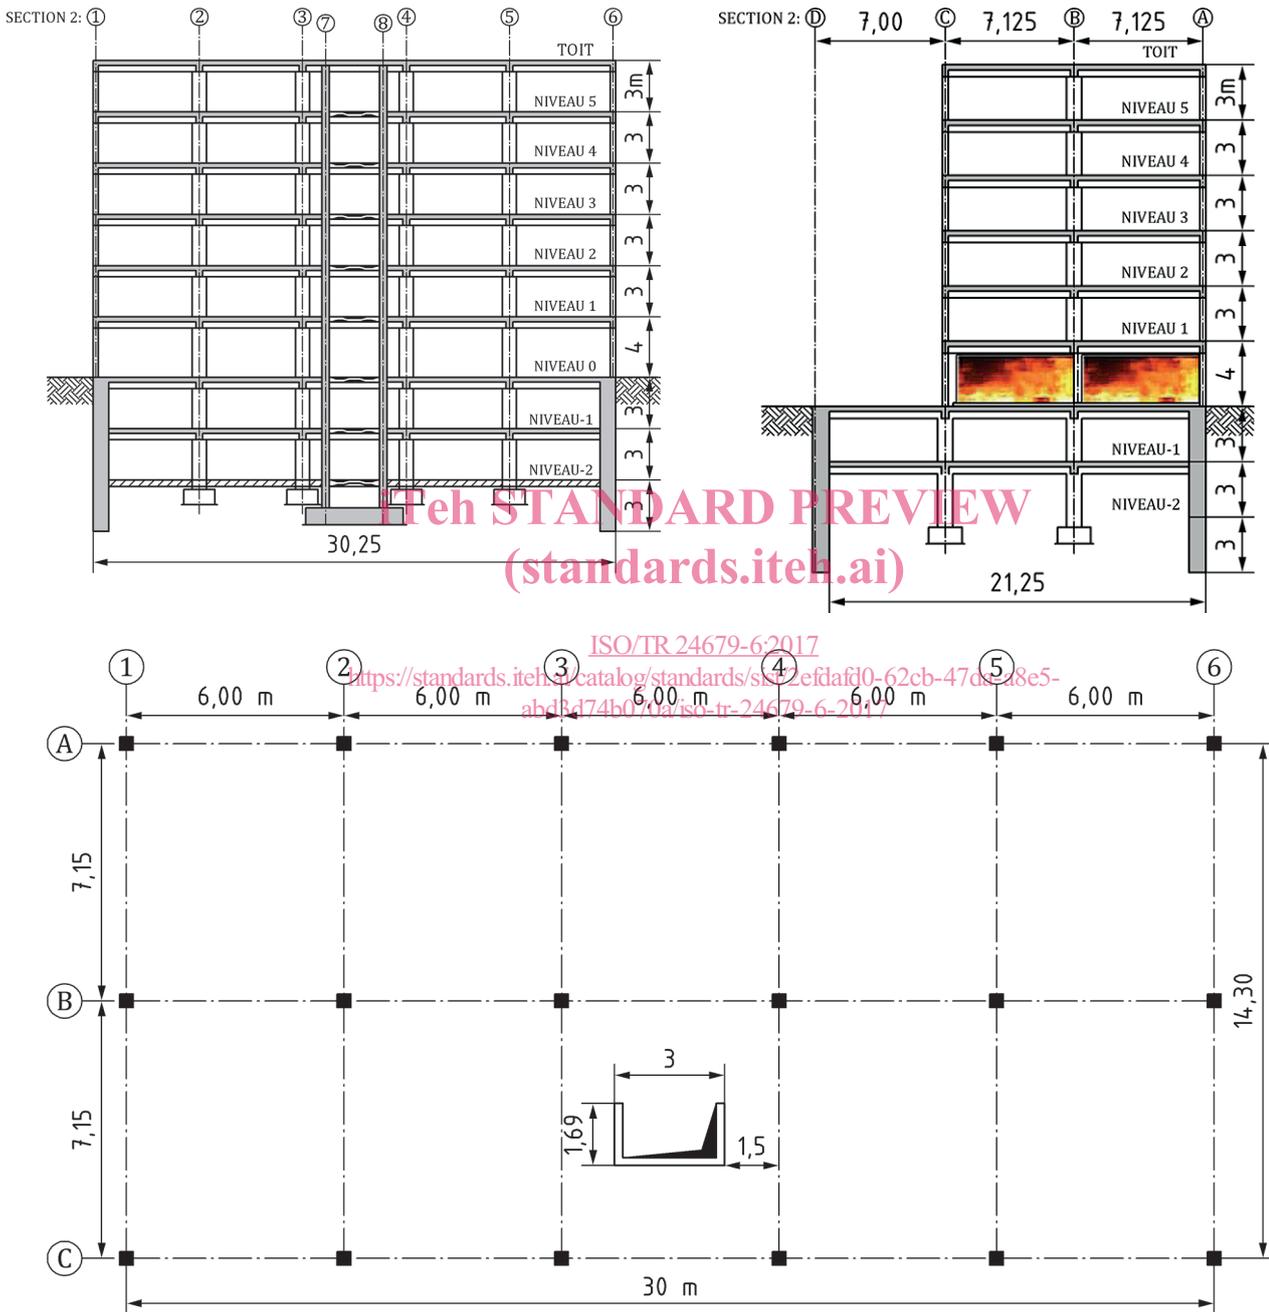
Plan et élévation de la structure, dimensions en mètres
